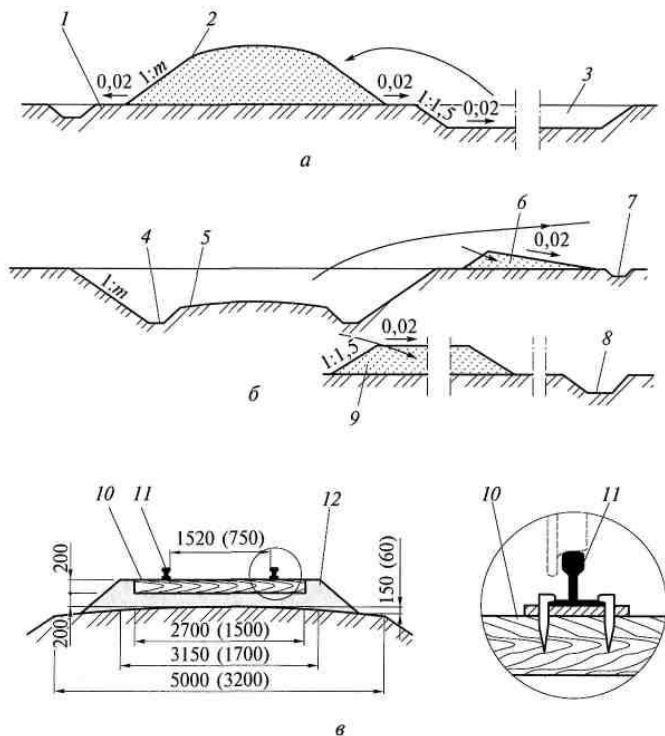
Поперечные профили железнодорожного пути: *а* – земляного полотна на насыпи; *б* – земляного полотна на выемке; *в* – верхнего строения (в скобках размеры для узкой колеи); 1 – берма; 2 – насыпь; 3 – резерв; 4 – кювет; 5 – бровка выемки; 6 – банкет; 7 – канава банкетная; 8 – канава нагорная; 9 – кавальер; 10 – шпалы; 11 – рельсы; 12 – балластный слой
